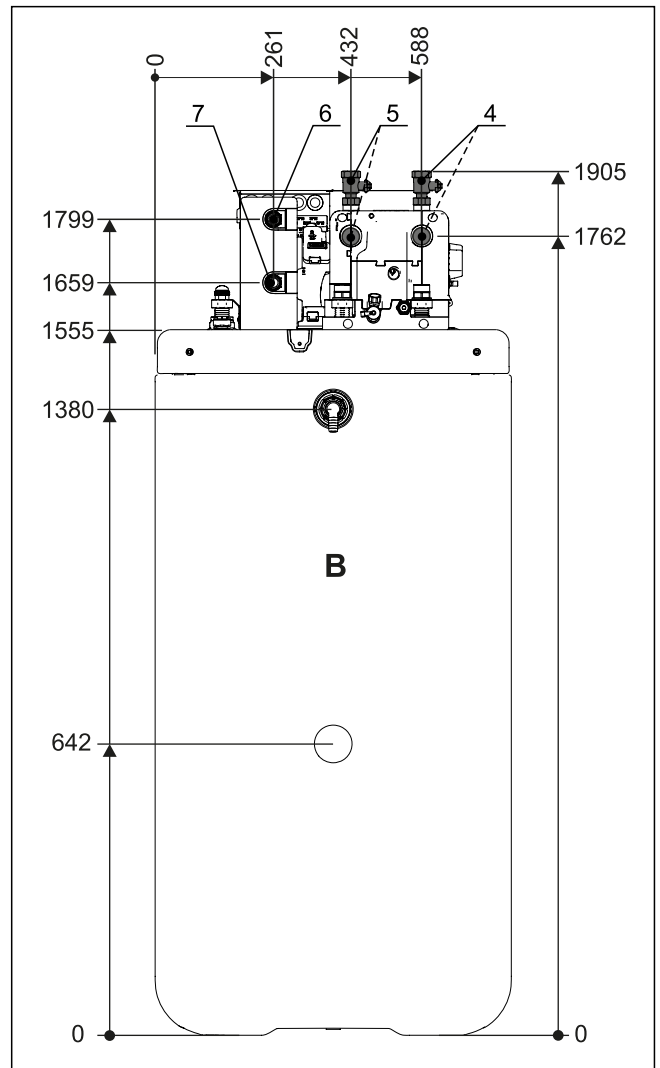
Abmessungen Seitenansicht - Typ ETS(X/H)B16P50D
